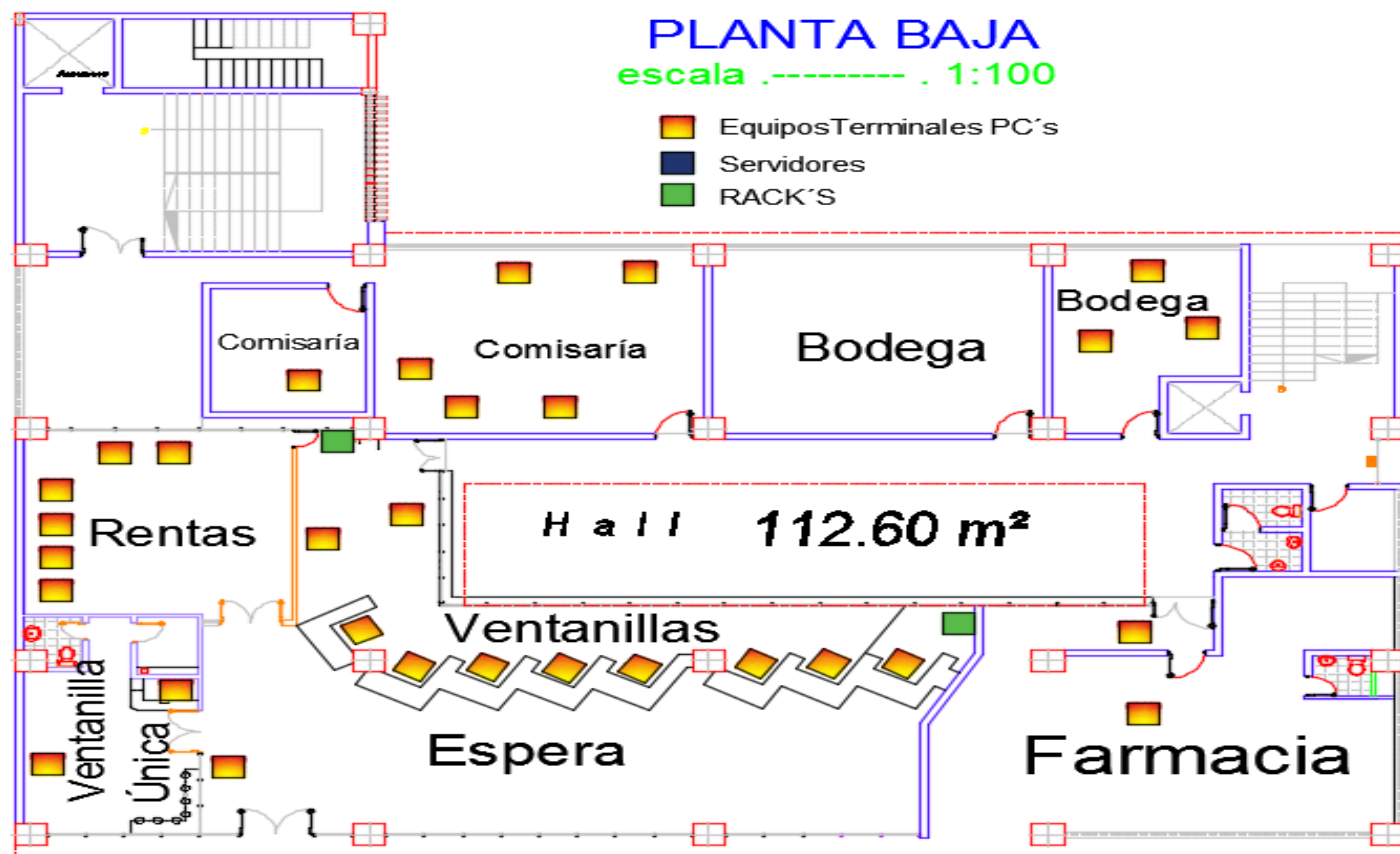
Plano de distribución actual de la red en la planta baja del edificio del G.A.D. Municipal de Tulcán.
